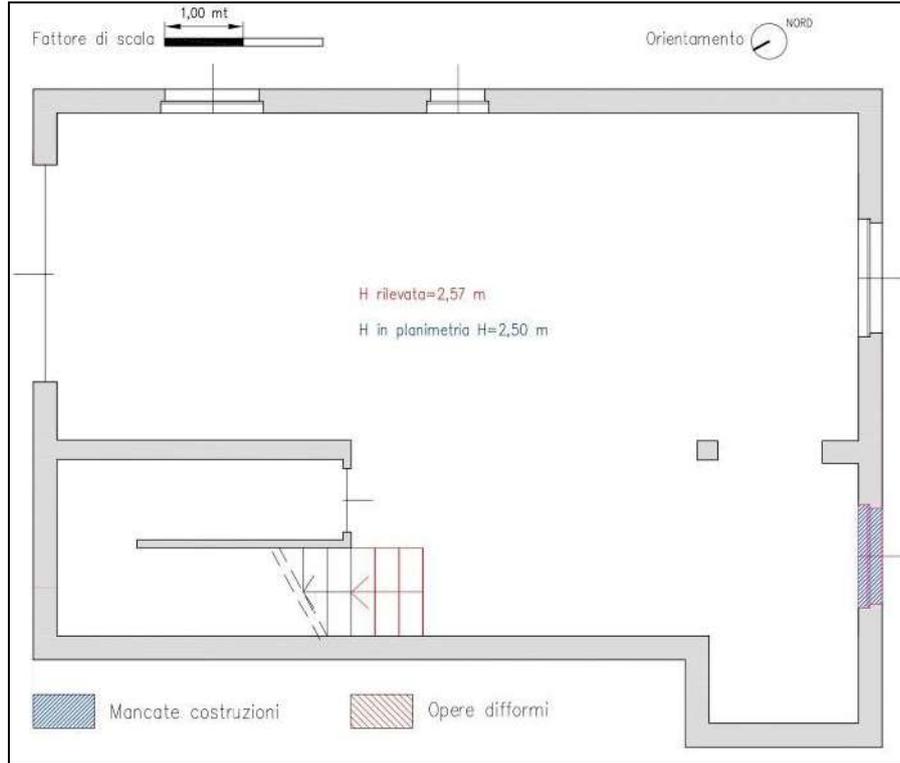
Pianta piano seminterrato - confronto con la planimetria catastale ultima in atti
